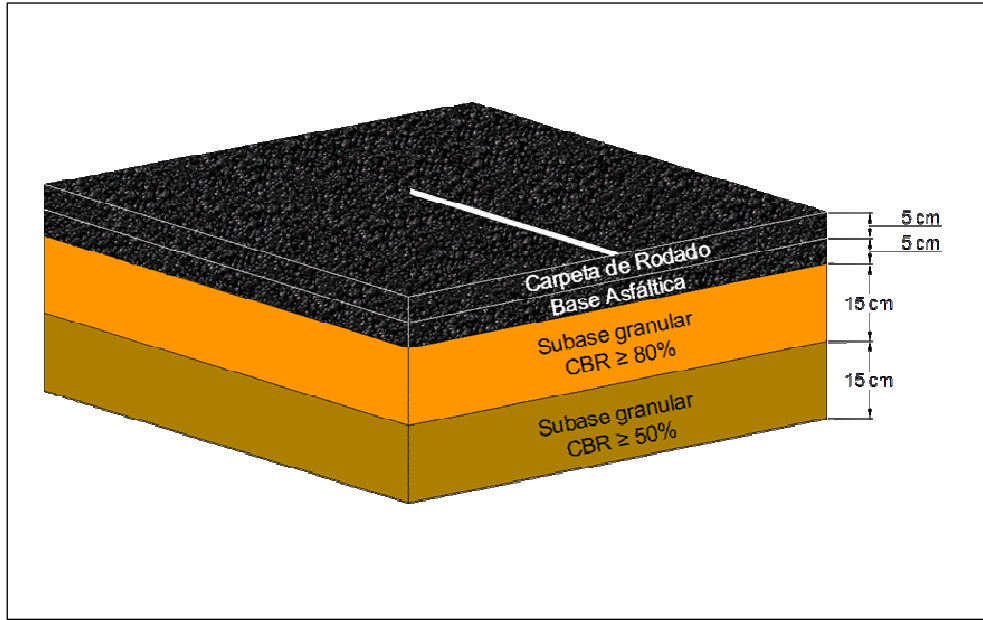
Esquema de la estructura de pavimento de asfalto construida según método N.R.B.
